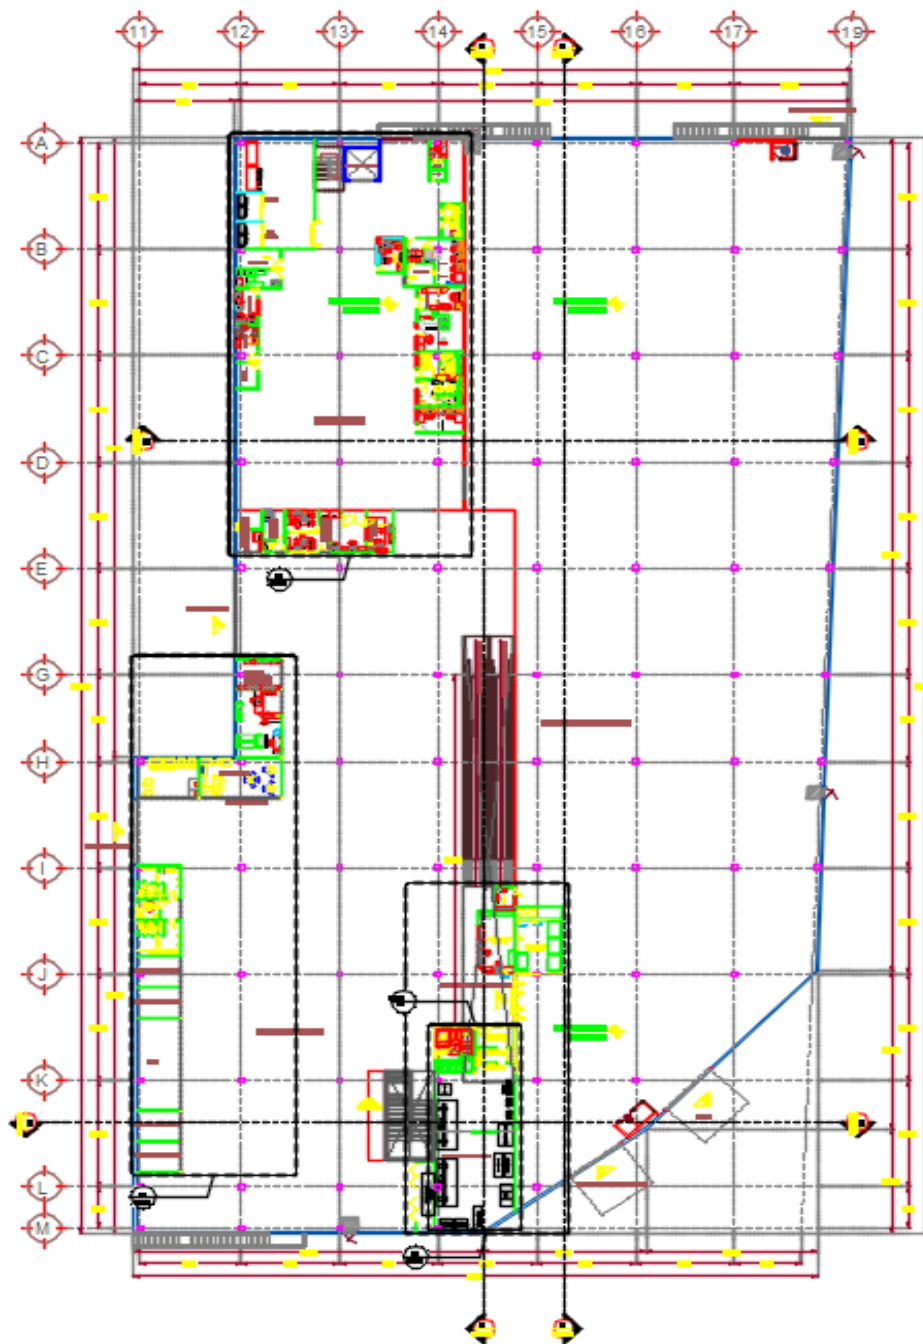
PLANTA BAJA PRIMER CUERPO (MAS PESADO)
